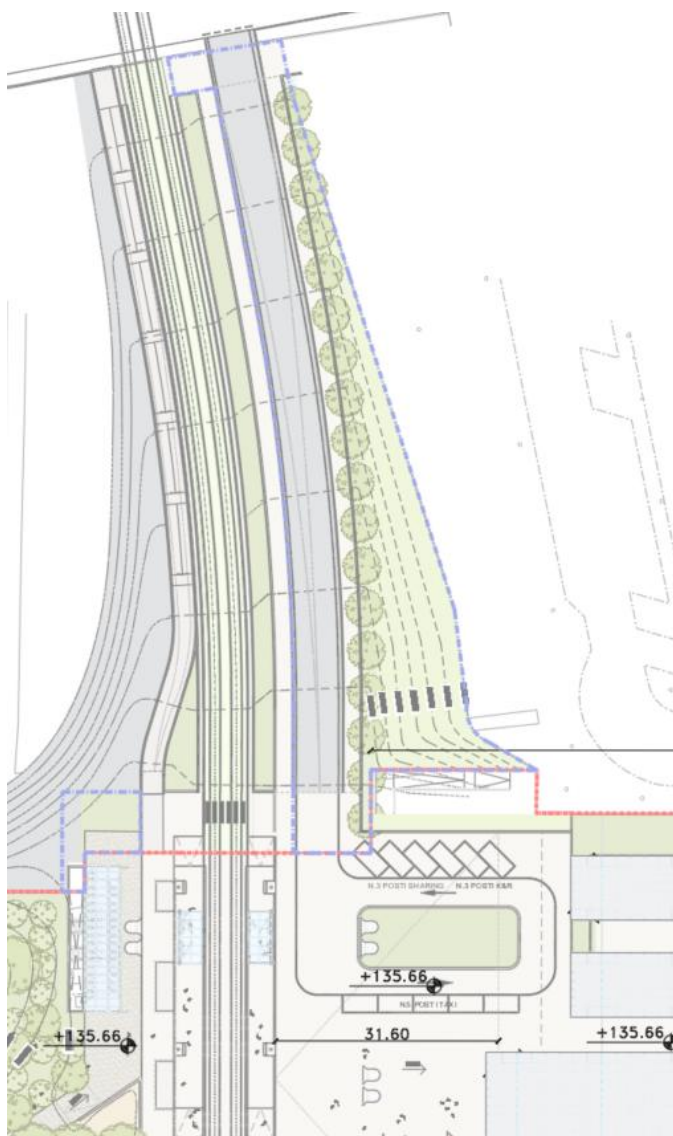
Estratto planimetria di inquadramento dell'ingresso est. (lato nord)
